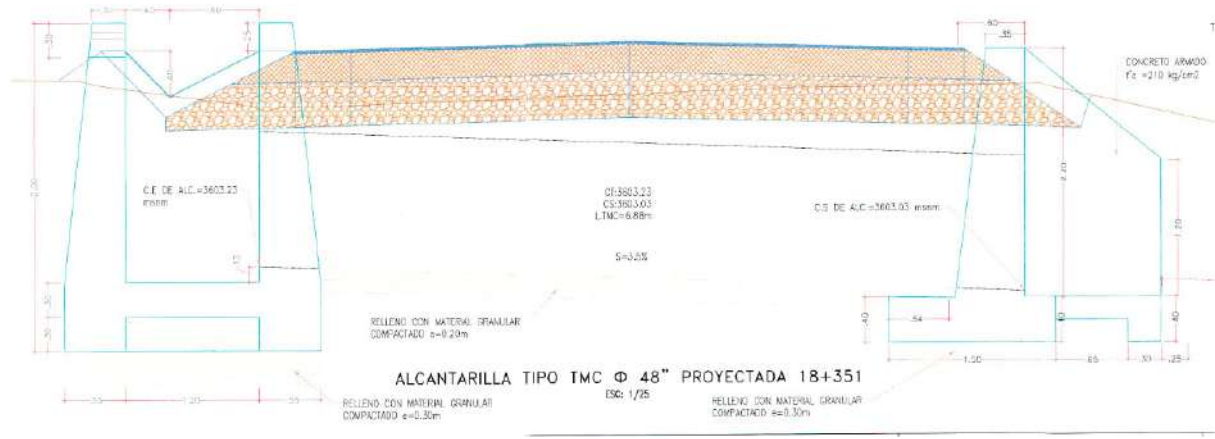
Sección transversal de alcantarilla proyectada 18+351 en el plano de Alcantarillas.
